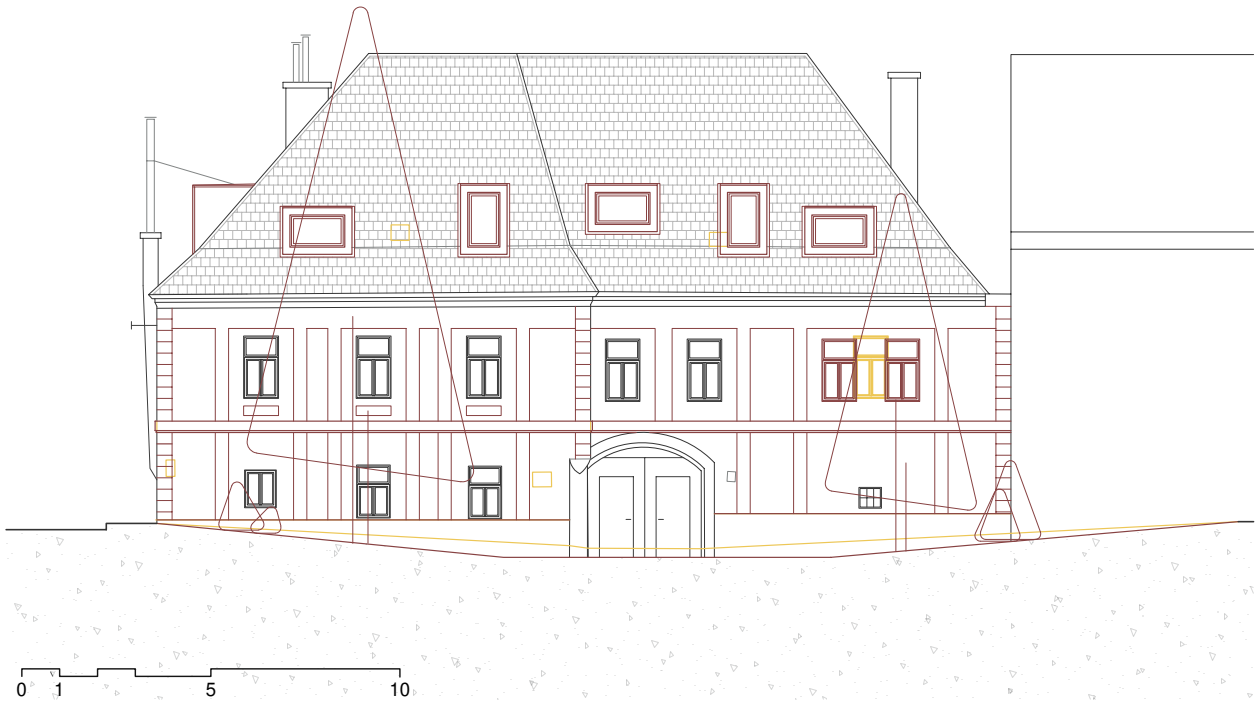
Bauliche Eingriffe Ansicht West M 1:200
